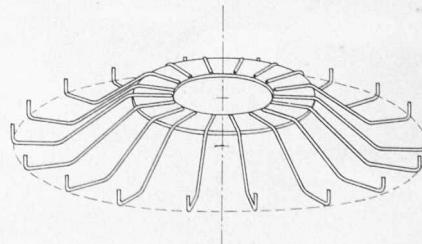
Blechring mit angeschweissten Runddeisen
